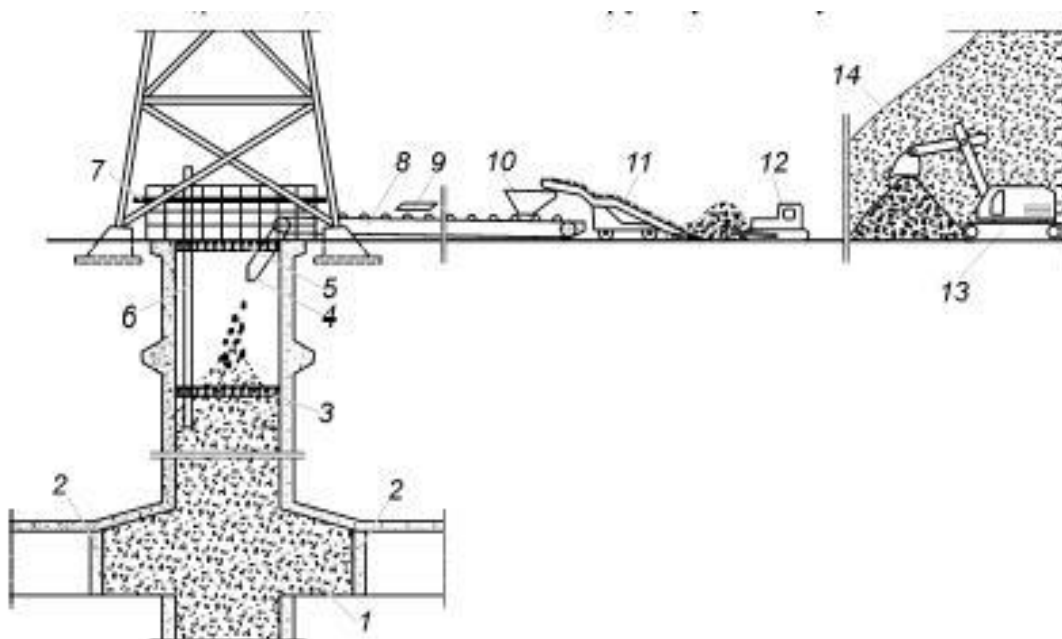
Технологічна схема ліквідації вертикального стовбура на момент вершення спорудження помосту перекриття стовбура: 1 – опора фундаменту; 2 – упорні перемички; 3 – поміст перекриття стовбура; 4 – розвантажувальний жолоб; 5 – газовідвідний трубопровід; 6 – трубопровід зрошення; 7 – конвеєр; 8 – електромагніт; 9 – бункер; 10 – породонавантажувальна машина; 11 – бульдозер; 12 – екскаватор; 13 – породний відвал.
